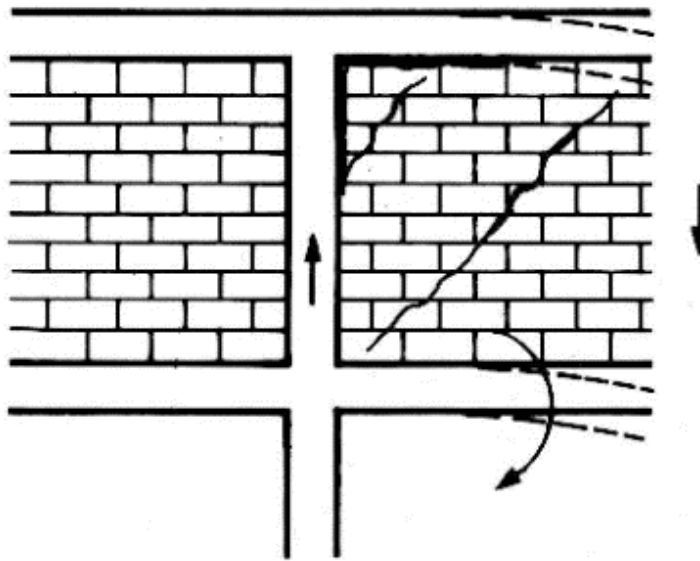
Fissuras devido à maior deformação do elemento estrutural superior em comparação ao elemento estrutural inferior.
